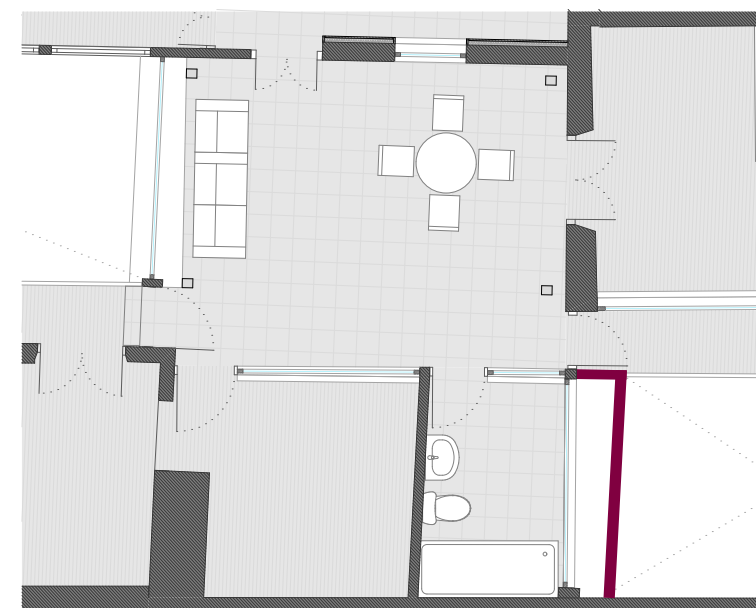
Esquema en planta | Confinación de espacios: sala y baño.
